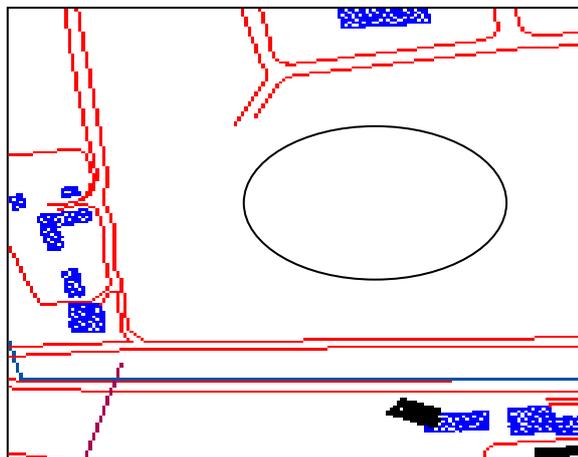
Vue en plan de l'assiette avant l'intervention
